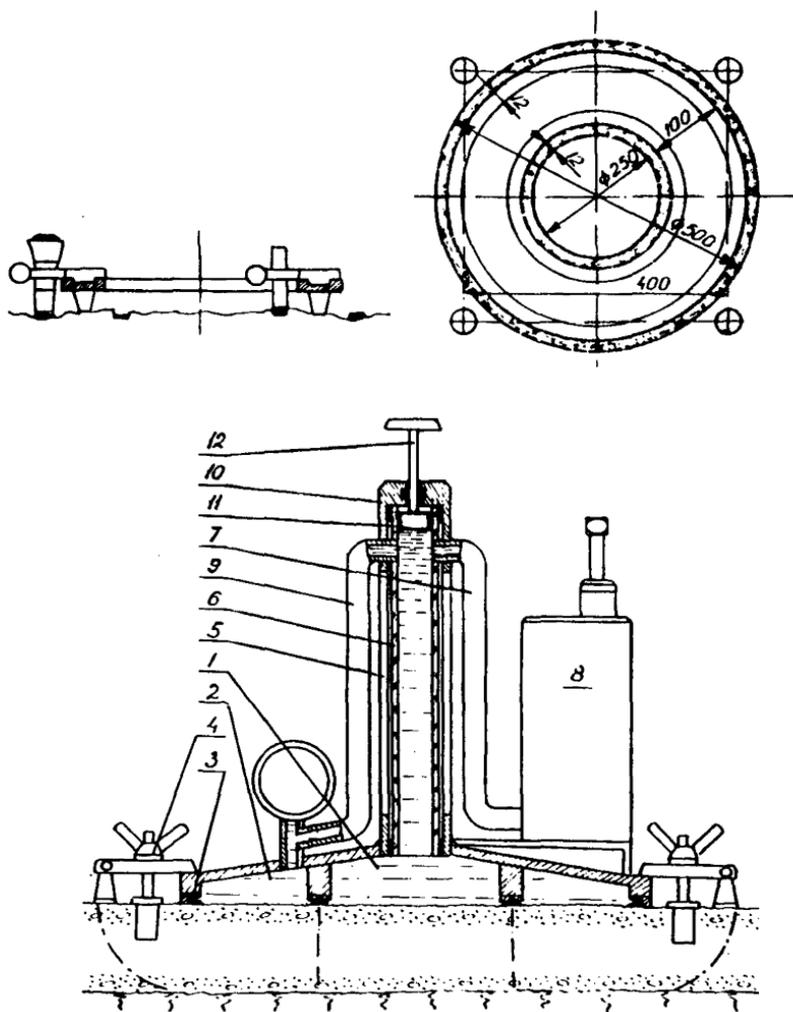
Схема напорной приставной камеры (вверху показана схема подготовки поверхности конструкции к установке камеры):
